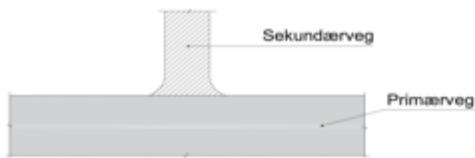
Kryss i plan. Skillet mellom kjørebaneer for primærveg og sekundærveg i T-kryss.
